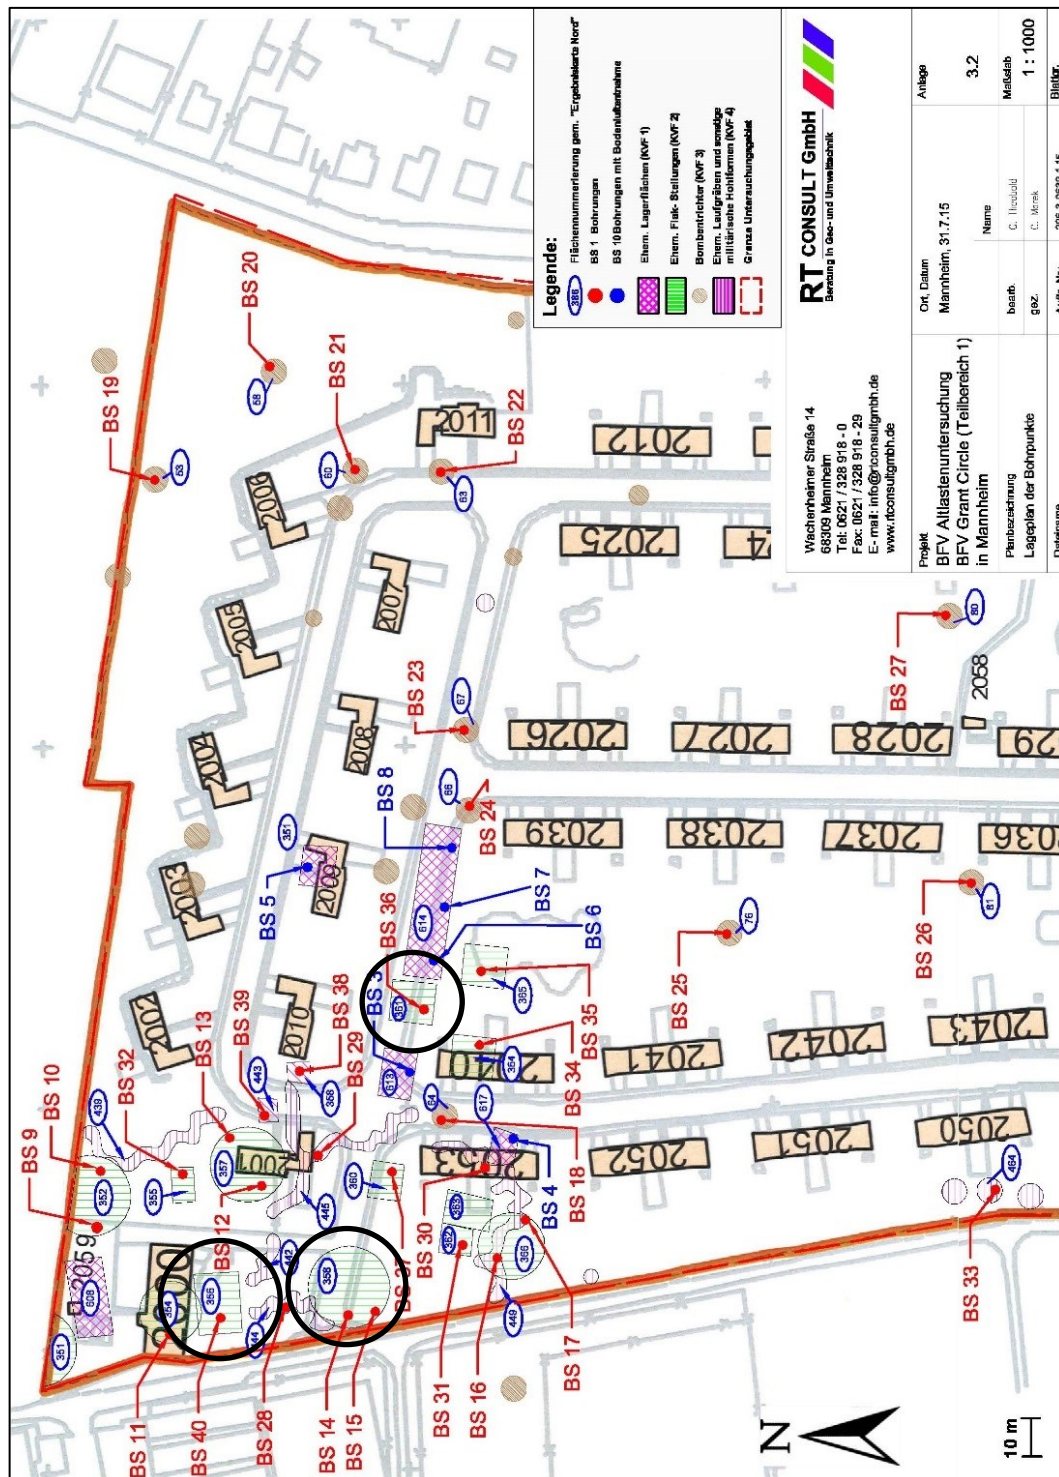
Altlastengutachten; Lageplan der Bohrpunkte
